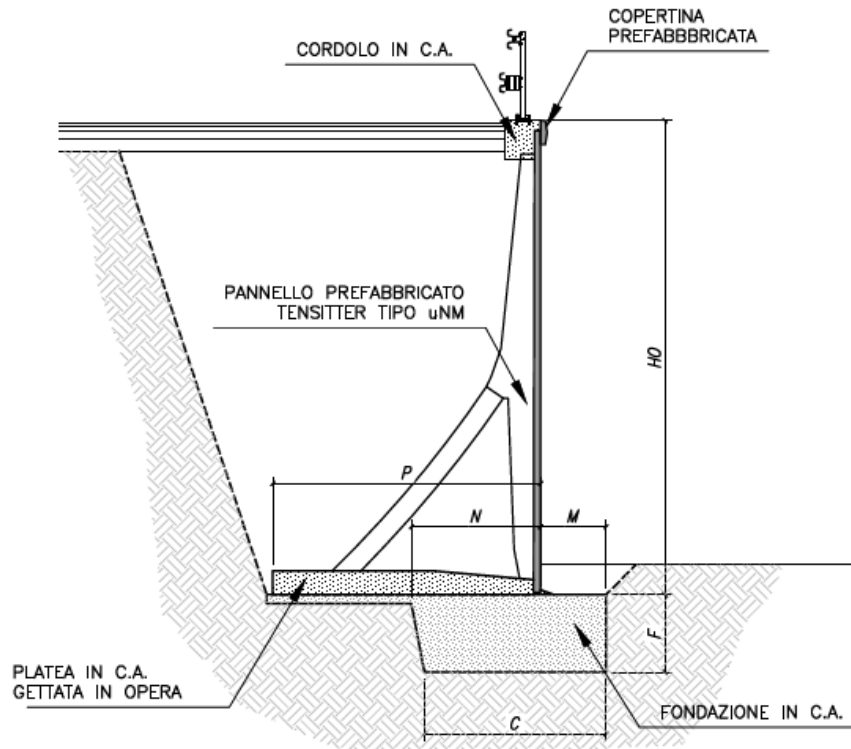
Sezione tipologica muro prefabbricato di tipo “uTM”
